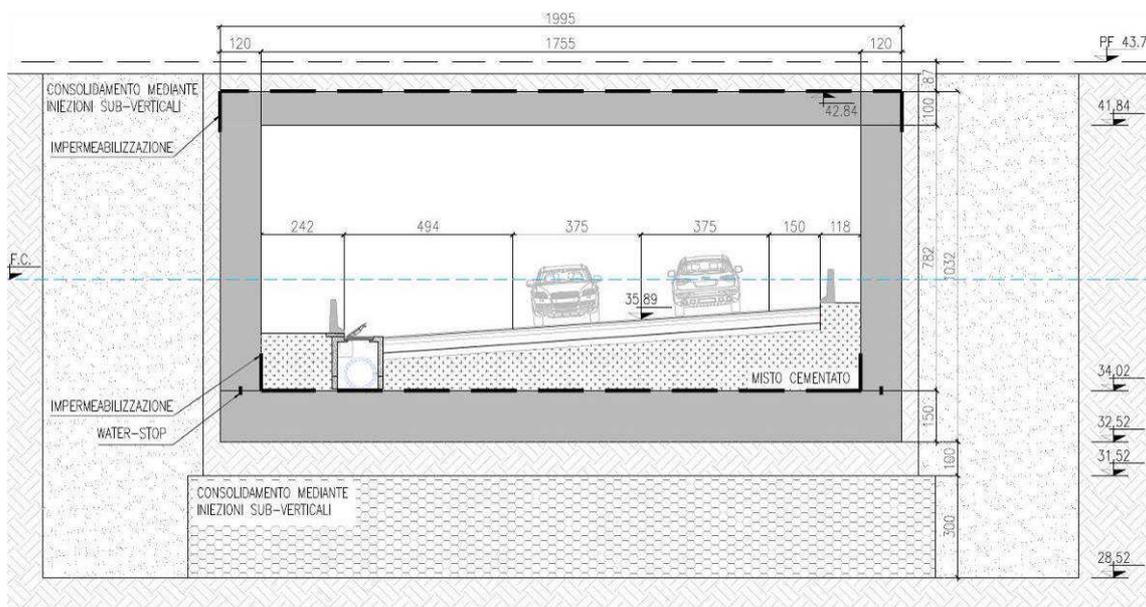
SEZIONE TRASVERSALE SOTTOVIA "FERROVIA MI-BO" (ESTRATTO DALL'ELABORATO T00ST05STRSZ01A)
